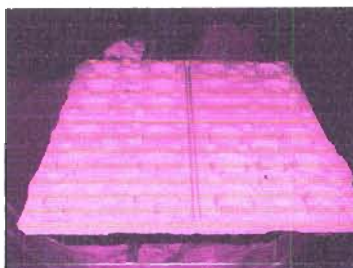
Placa molde (forma externa) ( fotografia do autor)
